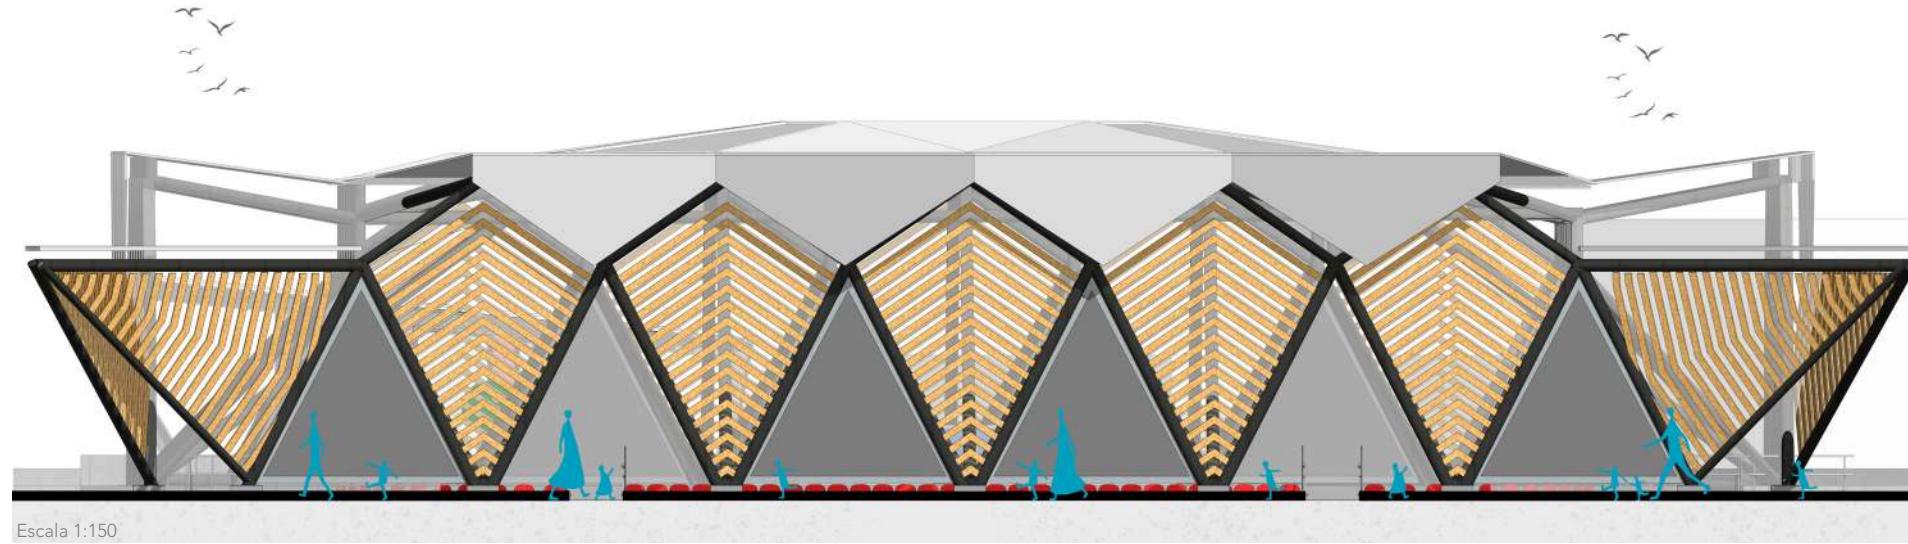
Fachada Frontal, Coliseo. Elaboración propia, 2024.
